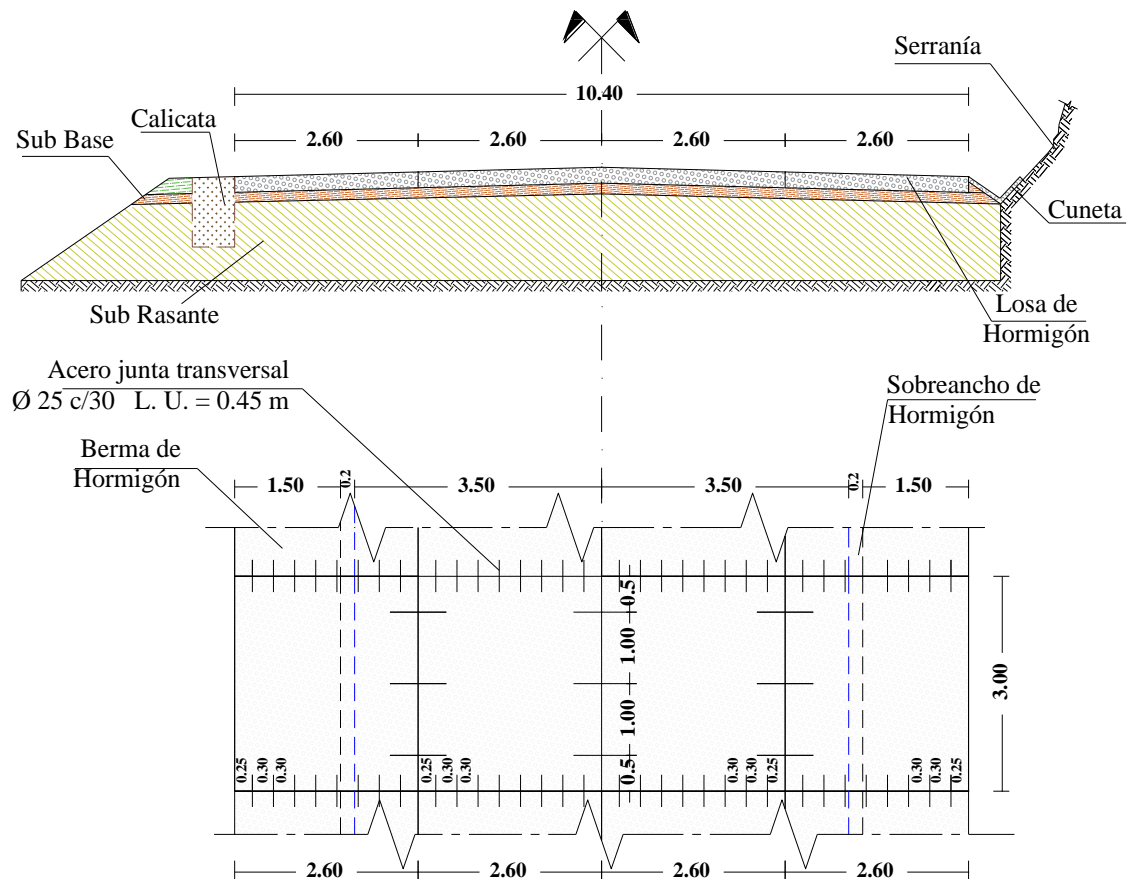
Vista en planta y sección transversal del pavimento en la progresiva 6+000
